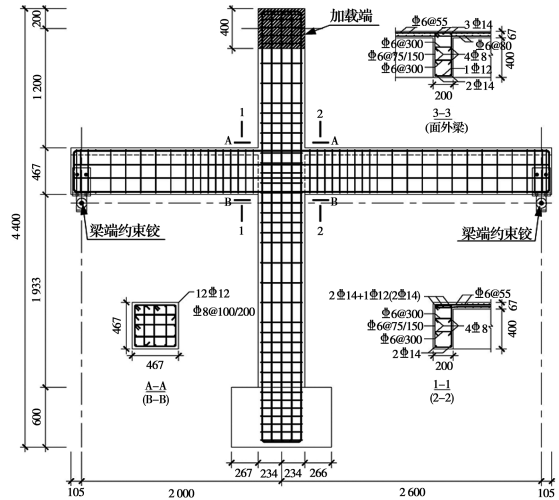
试验体 RCJ-1.1 尺寸和配筋图 (mm)
